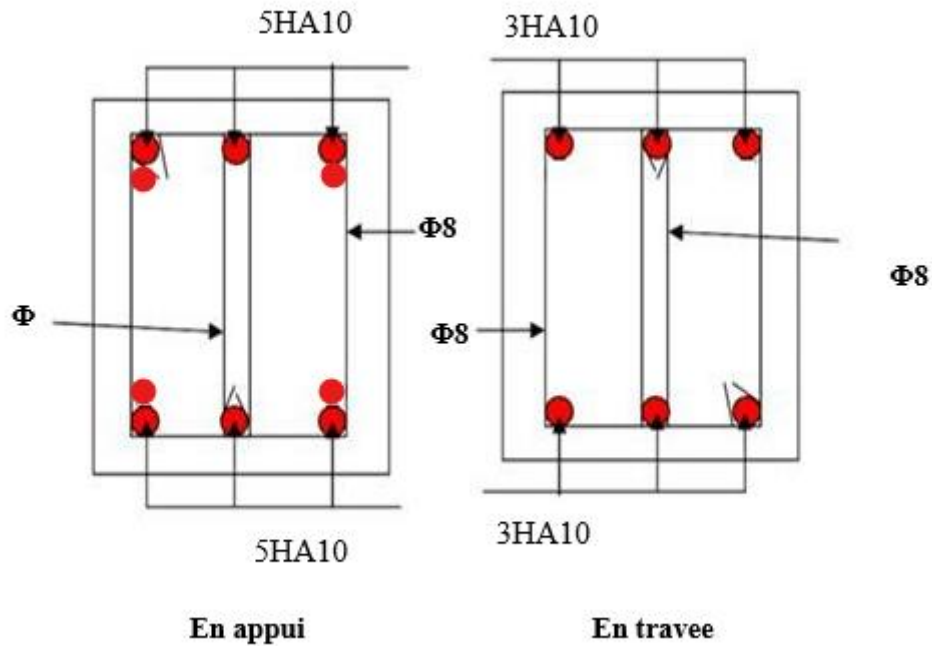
Schéma de ferrailage des poutres secondaire.
